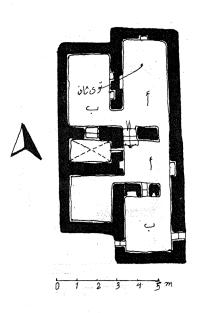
منزل محمد زيهان الدور الأول - مسقط أفقى
